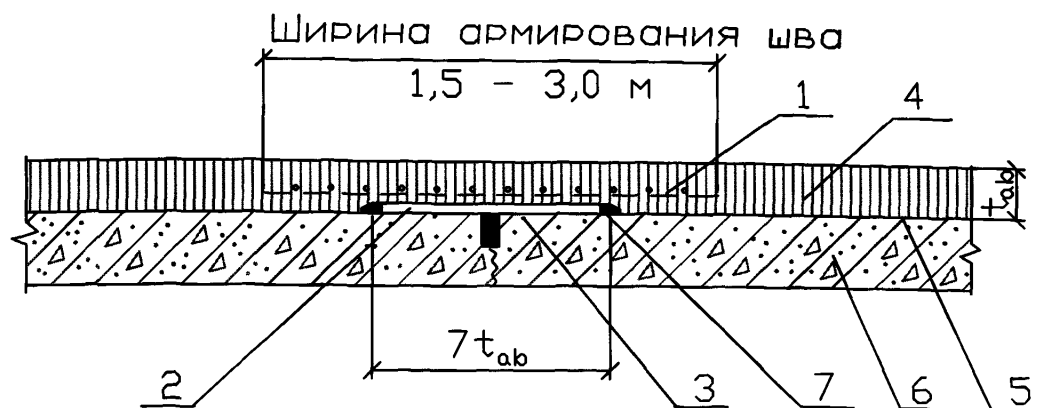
Конструкция армирования однослойного асфальтобетона геосетками ССНП над швом жесткого покрытия
